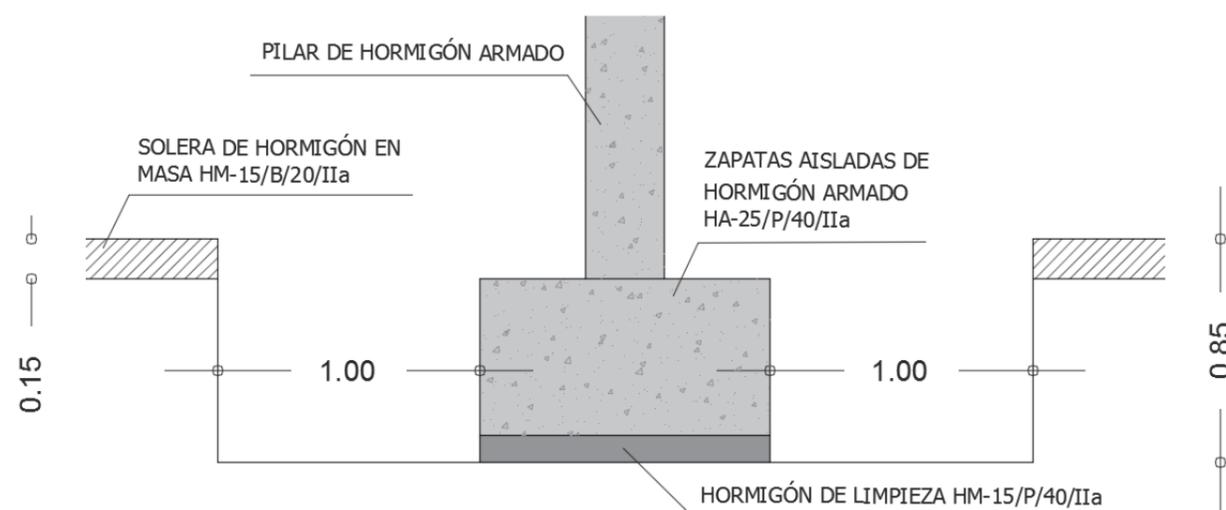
Detalle excavación alrededor de la zapata. 2018. Elaboración propia
